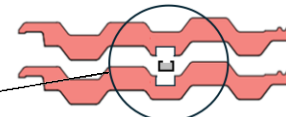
Montage patte de fixation pour tuiles à emboîtement ou à glissement
